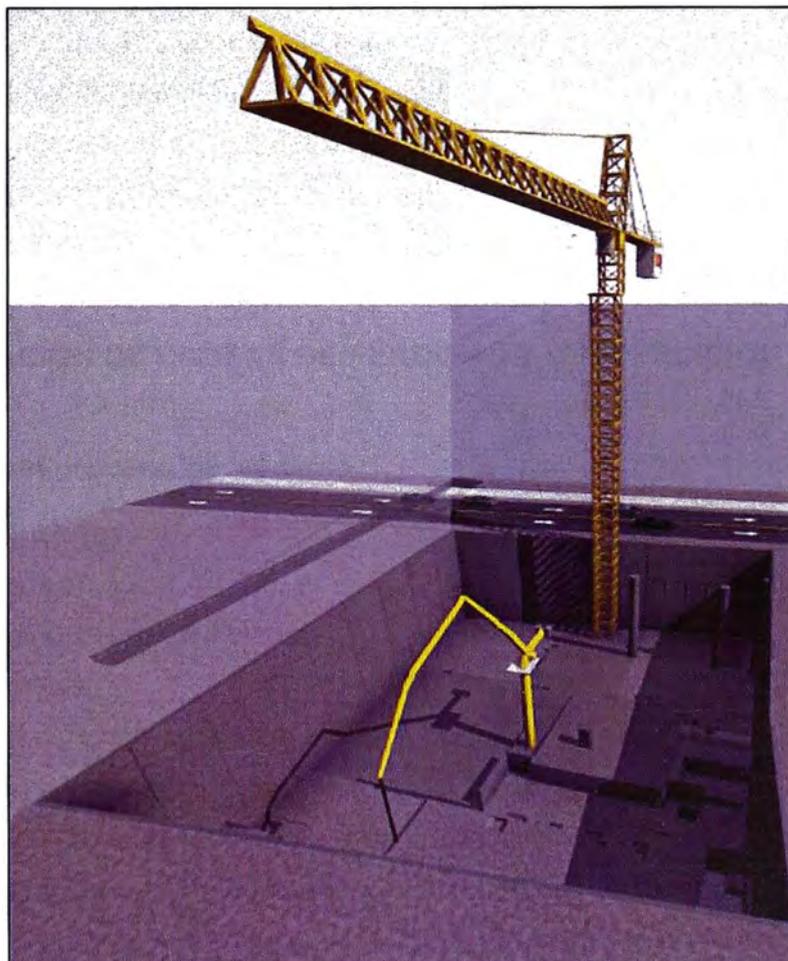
Modelamiento en BIM de la Pluma Autotrepante
